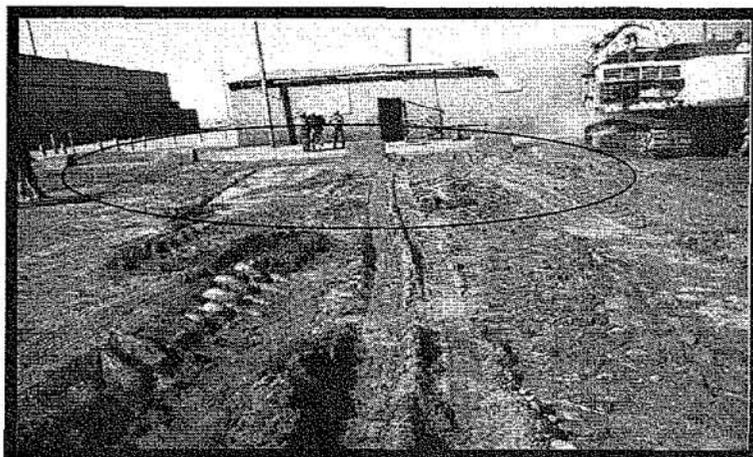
Otra vista del lavadero de equipo pesado donde se han formado lodos producto del lavado de los equipos pesados, por obstrucción de las canaletas y también contaminando suelo contiguo a la plataforma.
